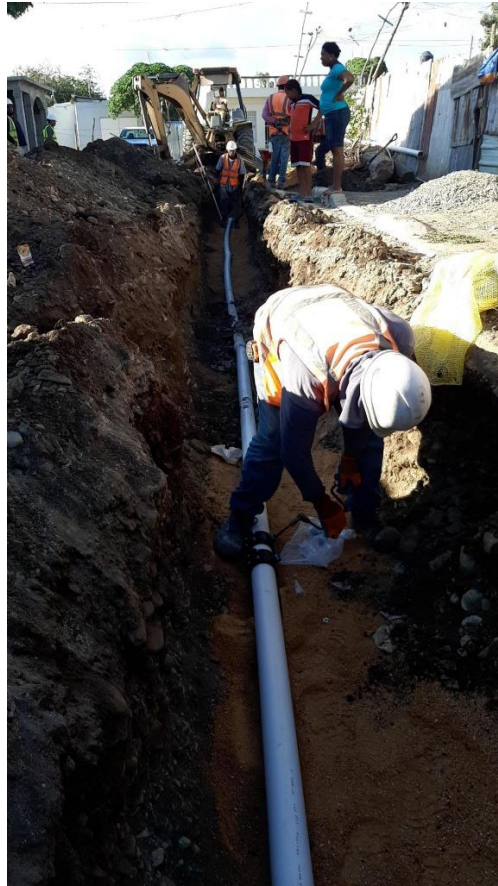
Colocación de Tubería PVC 3" SDR26
